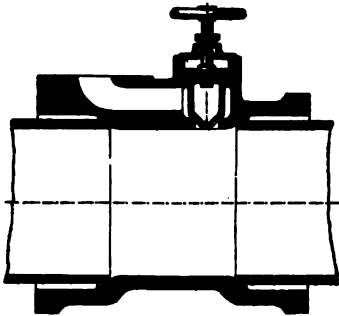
Hilfsmuffen-Abzweigstück mit Absperrventil zur Entlüftung. (Reuther.)
